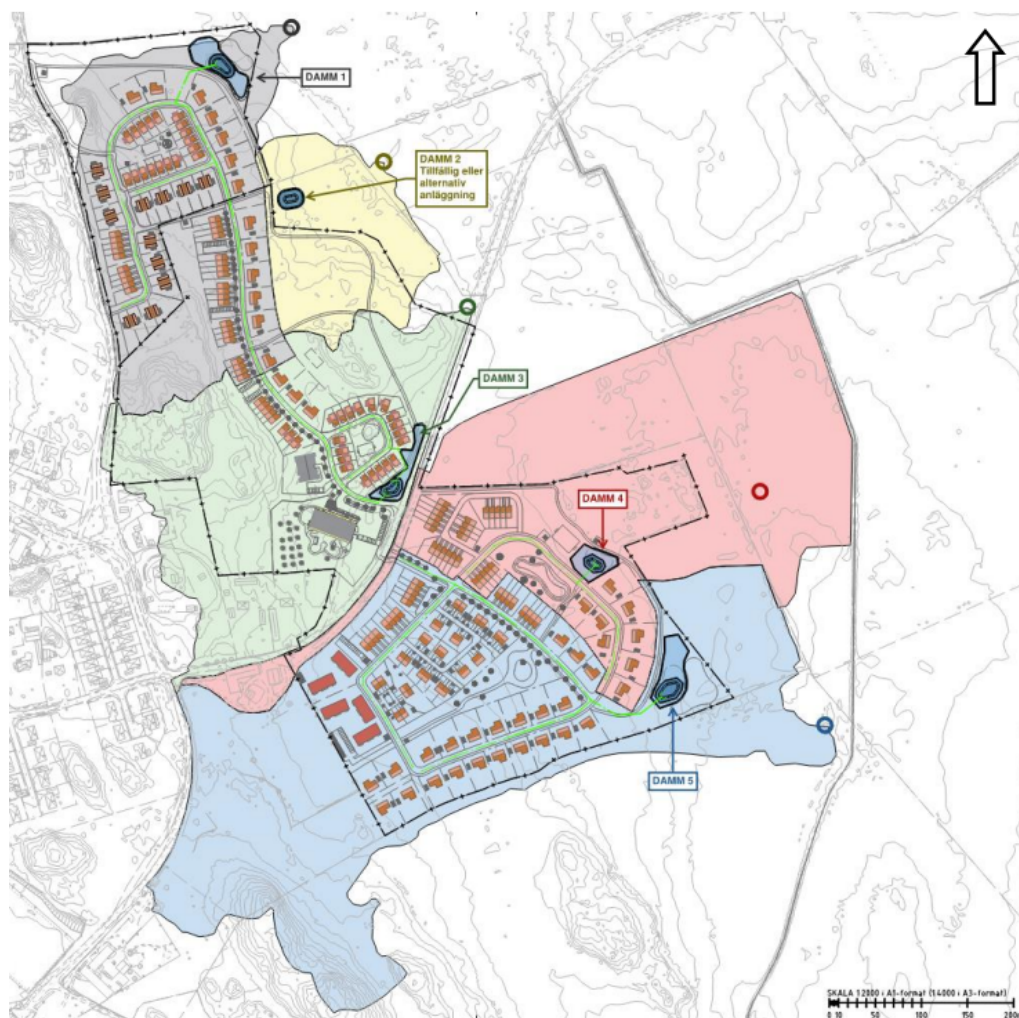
Illustration över föreslagen hantering av dagvatten inom detaljplanen och Detaljplan för Gysta 1:13. Structor.
